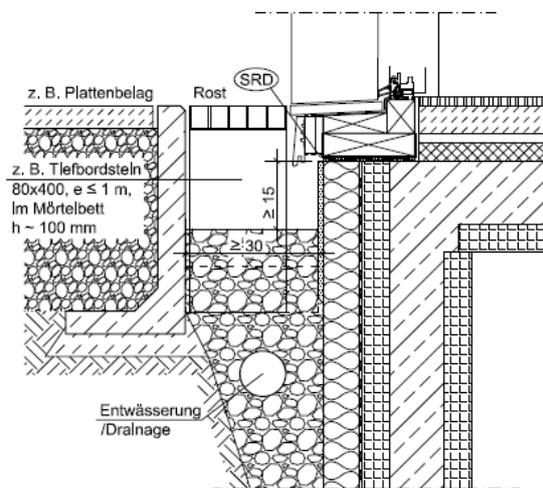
Terrasse mit Fenstertüre und Holzfassade
